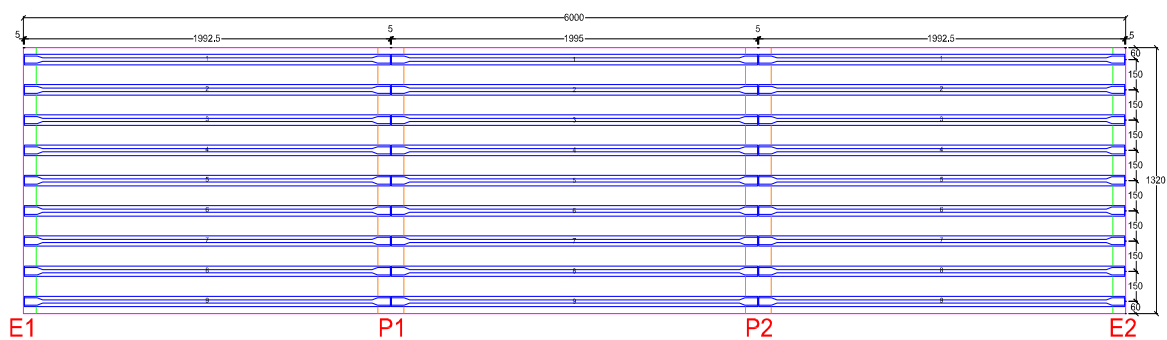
VISTA EN PLANTA DE LAS VIGAS DEL PUENTE DE PALANDA
